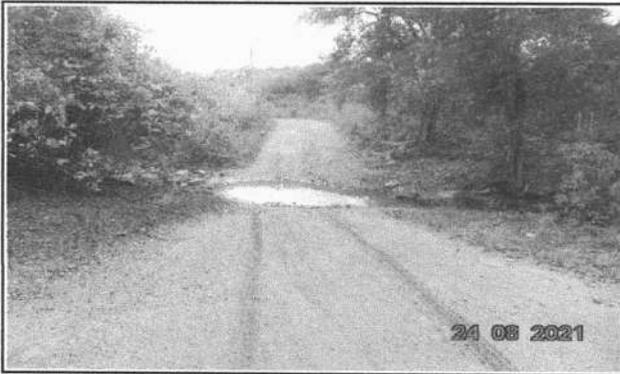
LOCAL DA CONSTRUÇÃO - BUEIRO
